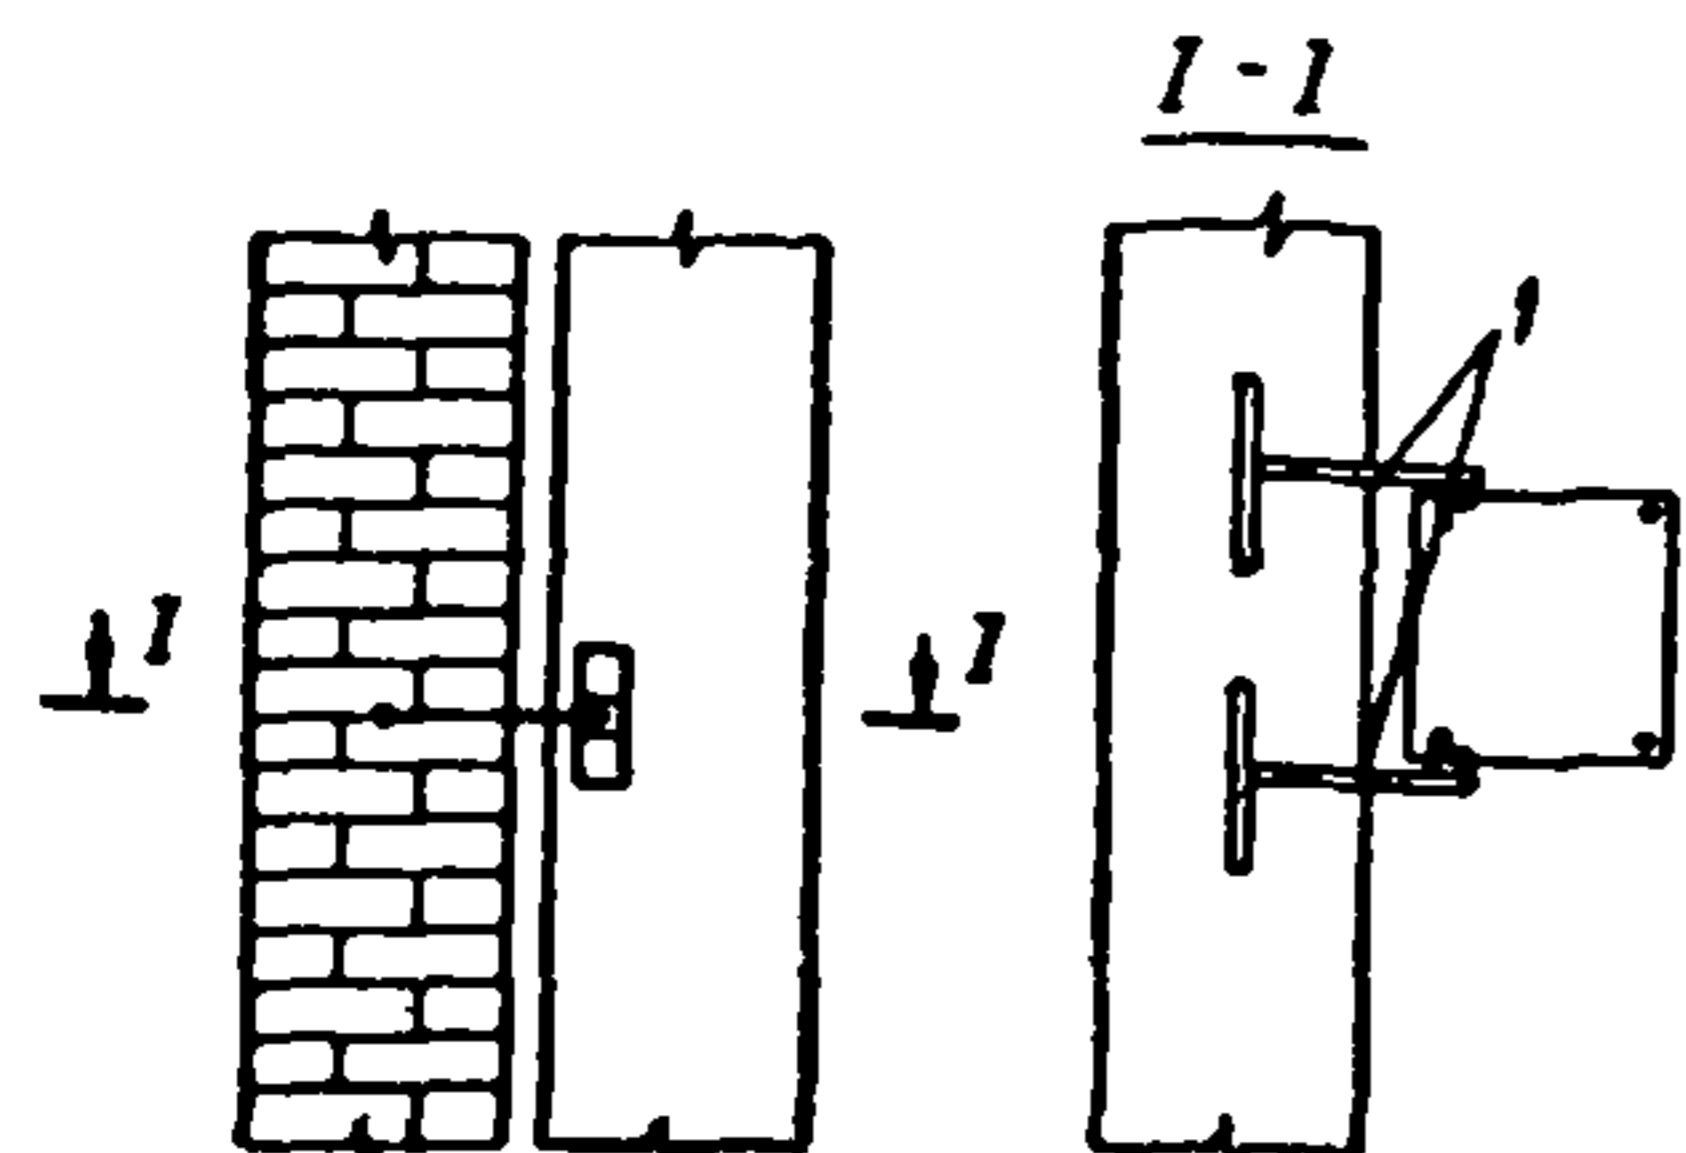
Гибкие связи для крепления самонесущих стен к каркасу
